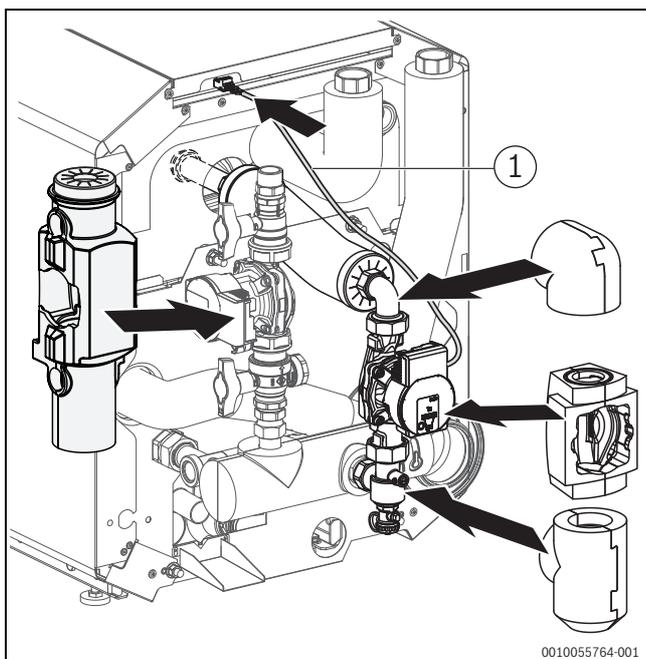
Montage Wärmeschutz und Anschlussleitung der Pumpe
